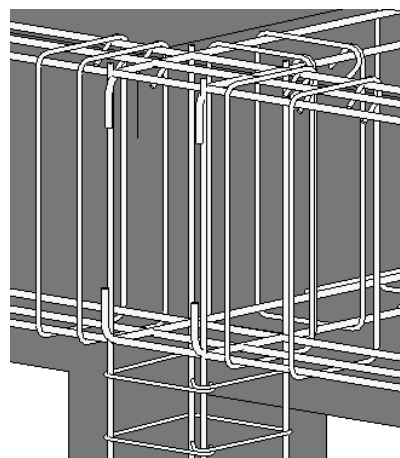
Nós do pórtico entre as vigas V3-3 e V3-9 e o pilar P10.
